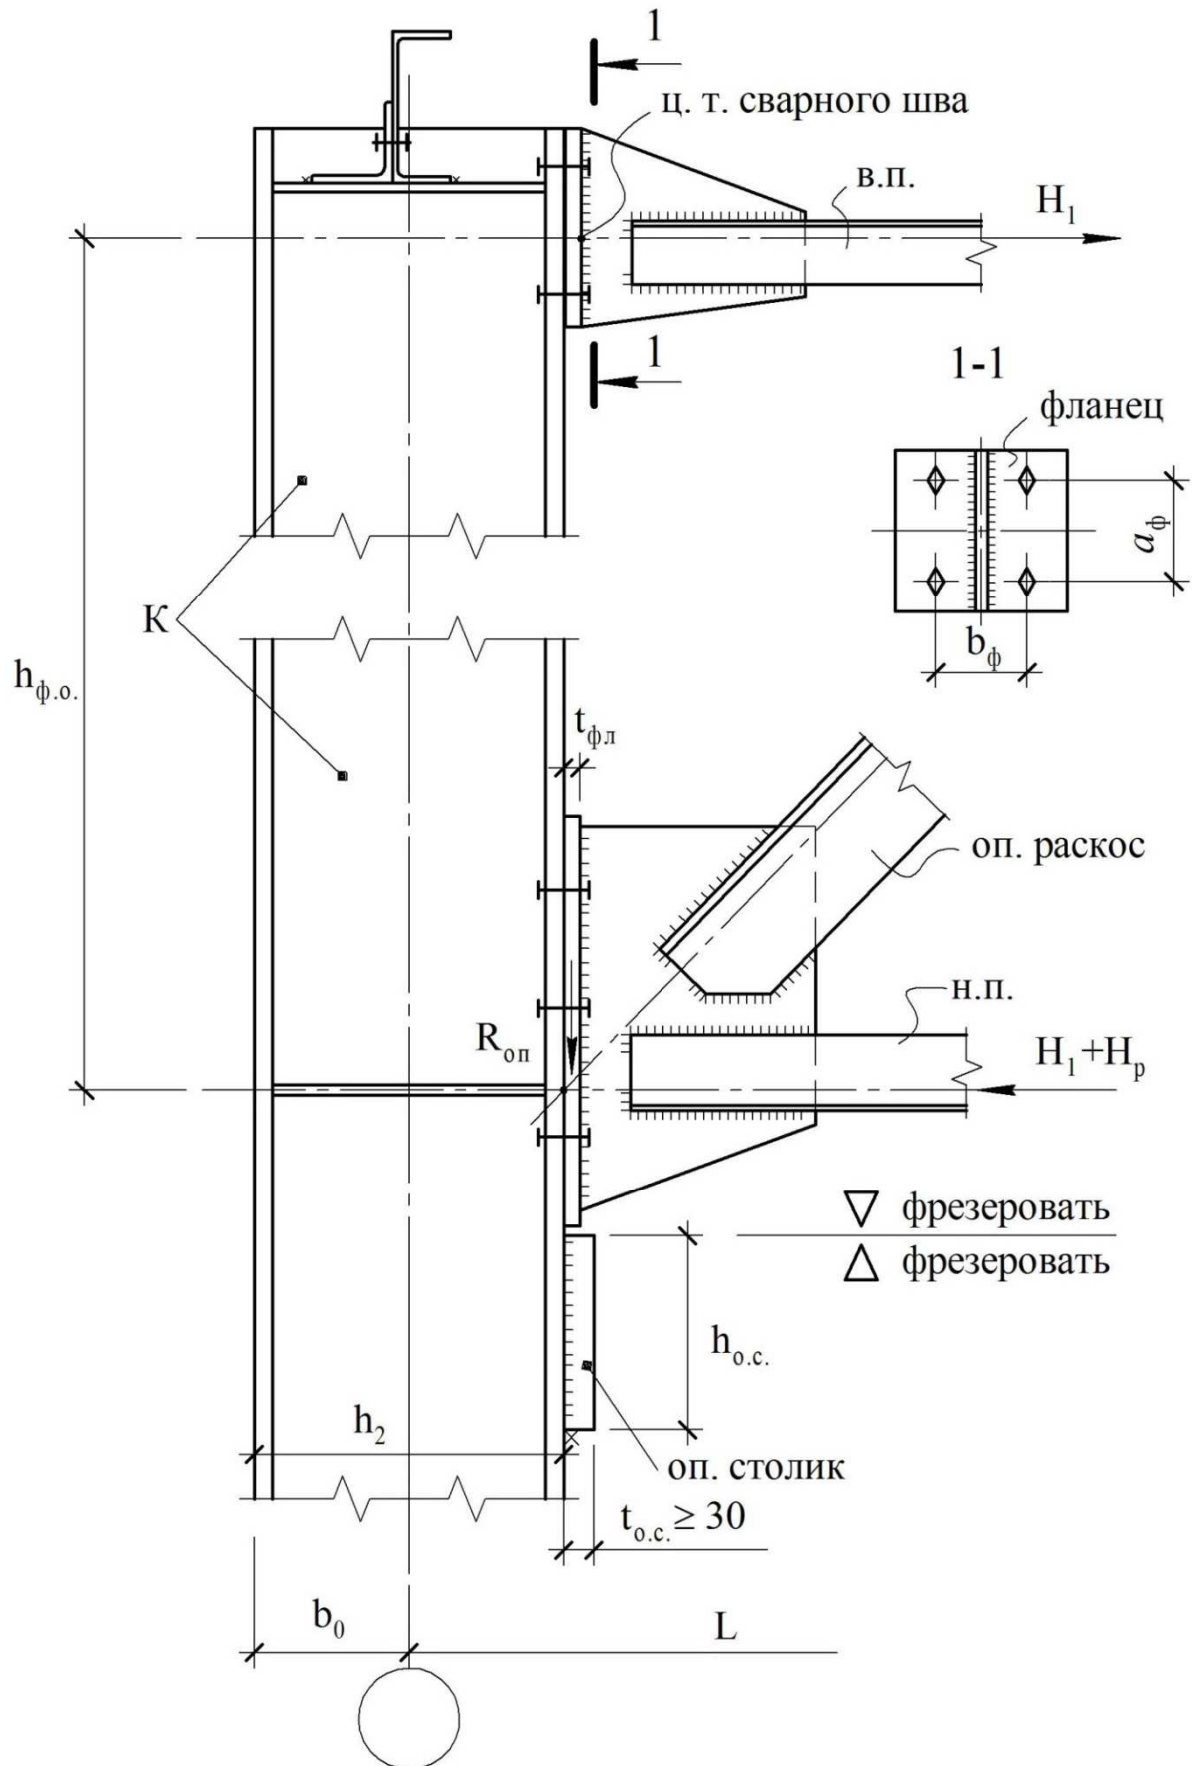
Жесткий узел опирания ригеля на колонну
